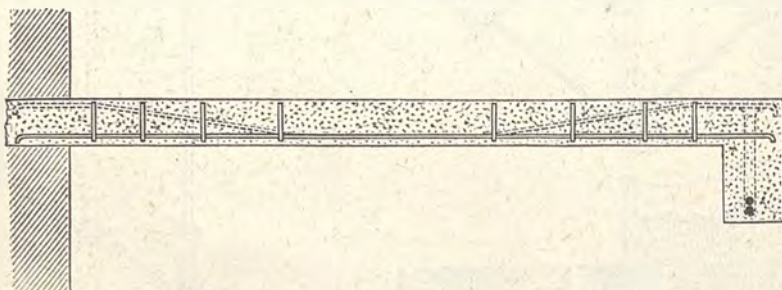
Sezione trasversale di una soletta per rampa in cemento armato con travetta di sponda.
